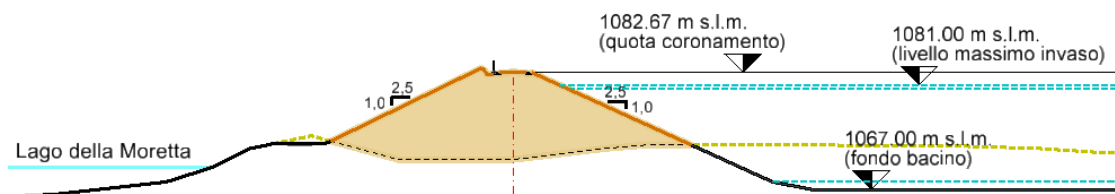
Sezione oggetto di verifica (Sezione B-B1).
